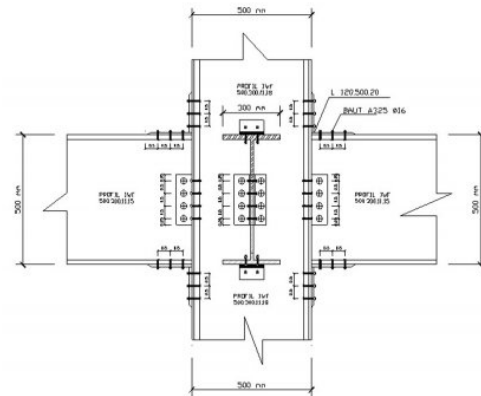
detail sambungan kolom kolom EF 500.300.11.18 dan WF 350.350.16.16
